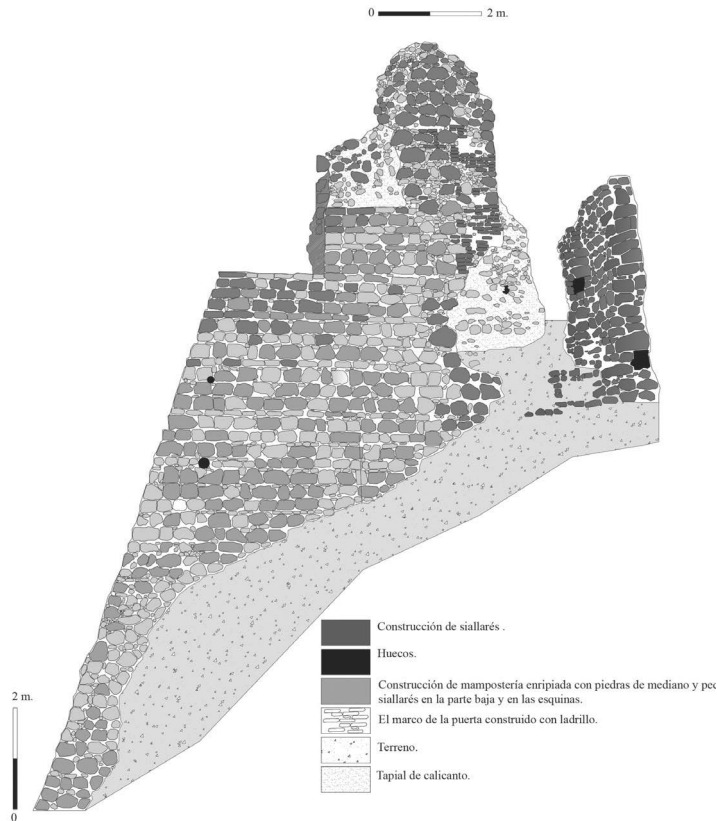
La puerta de la fortaleza en su cara exterior sureste la técnica constructiva es tapial de calicanto y mampostería enripiada. Las piedras son de diferente tamaño, se disponen verdugadas con ladrillo y piedras, y existe refuerzo de sillares.
